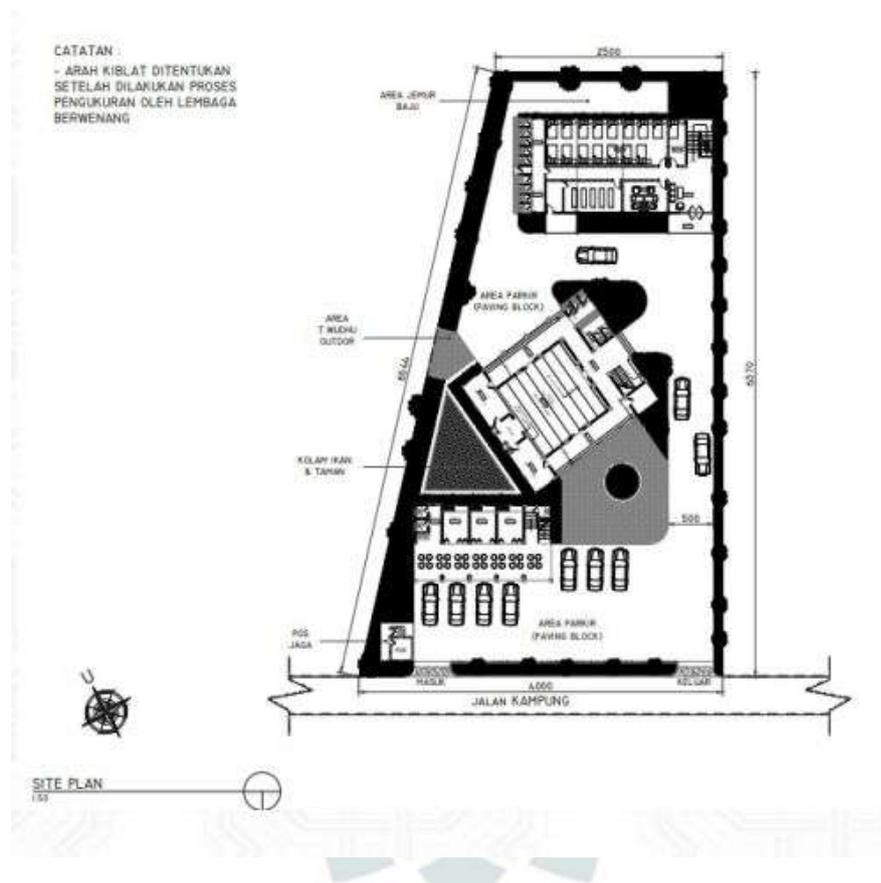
Site Plan Asrama Lantai Dasar Ma'had Aly Pondok Quran<sup>158</sup>
